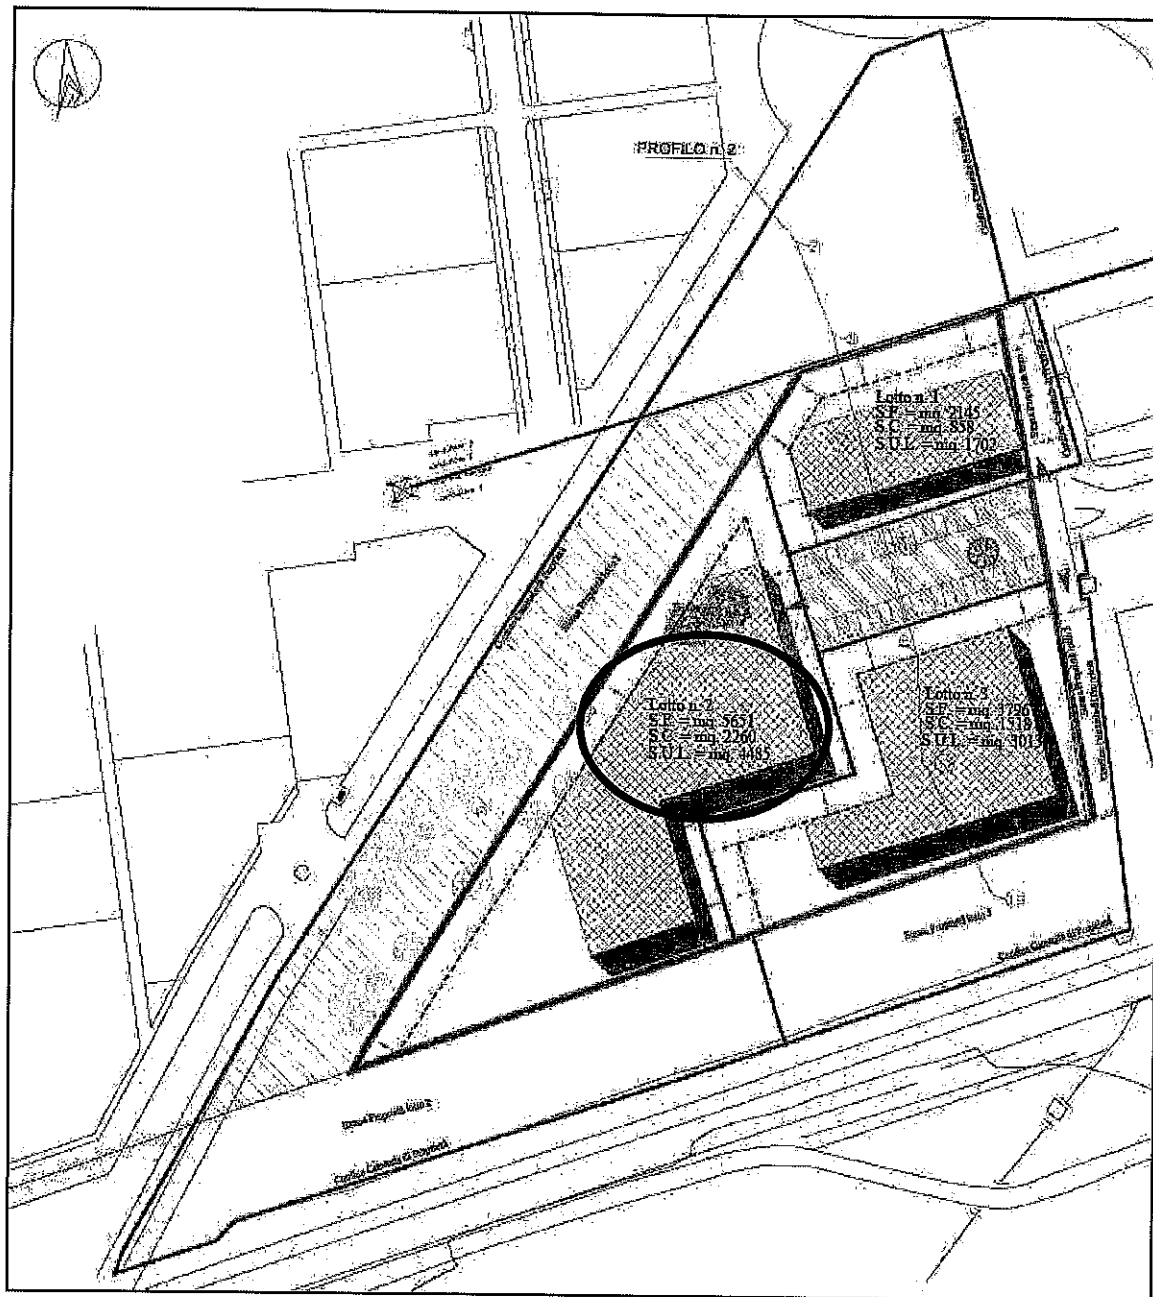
Estratto da Tav.2 di variante al P.A. con evidenziato il "Lotto 2"
